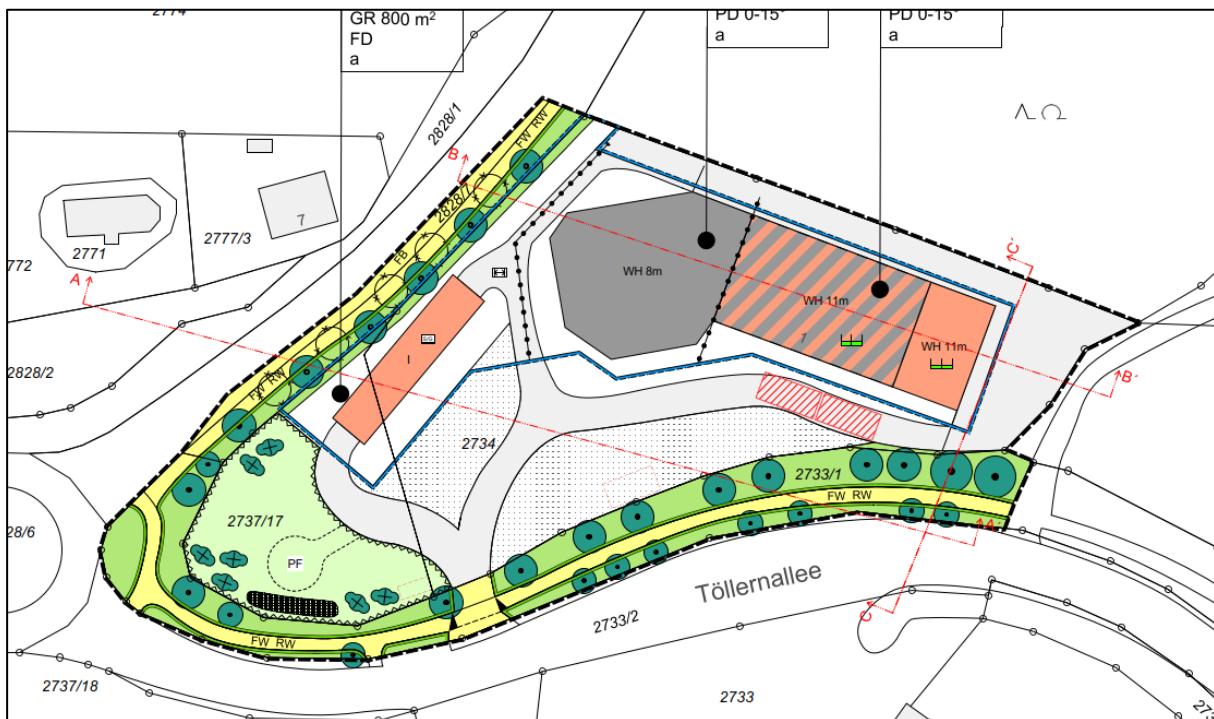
Plangebiet mit vorgesehener Bebauung [3], Stand: 02.05.2025
